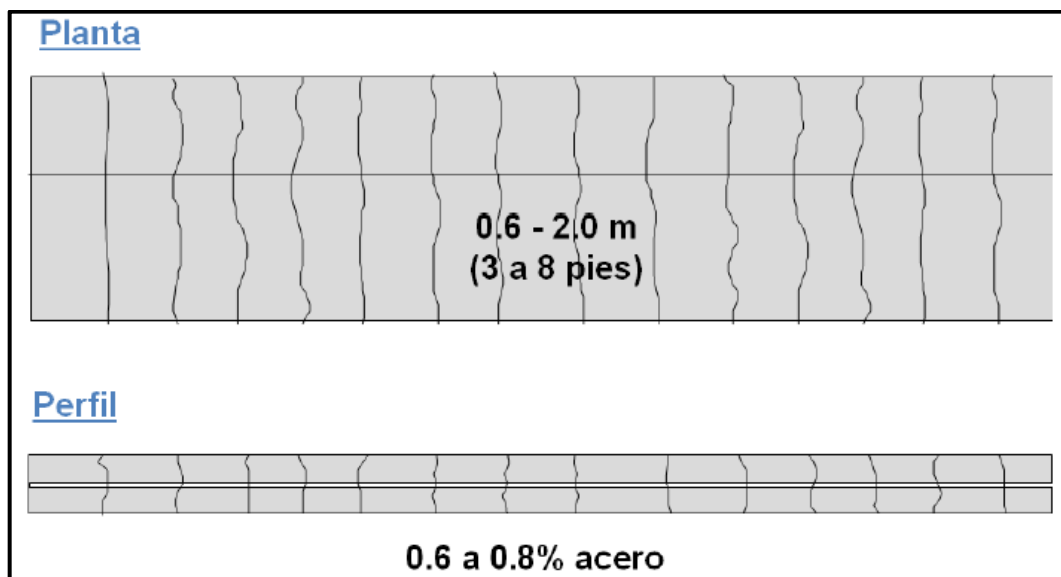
Esquema de pavimento de concreto continuamente reforzado. (Becerra, 2012)
